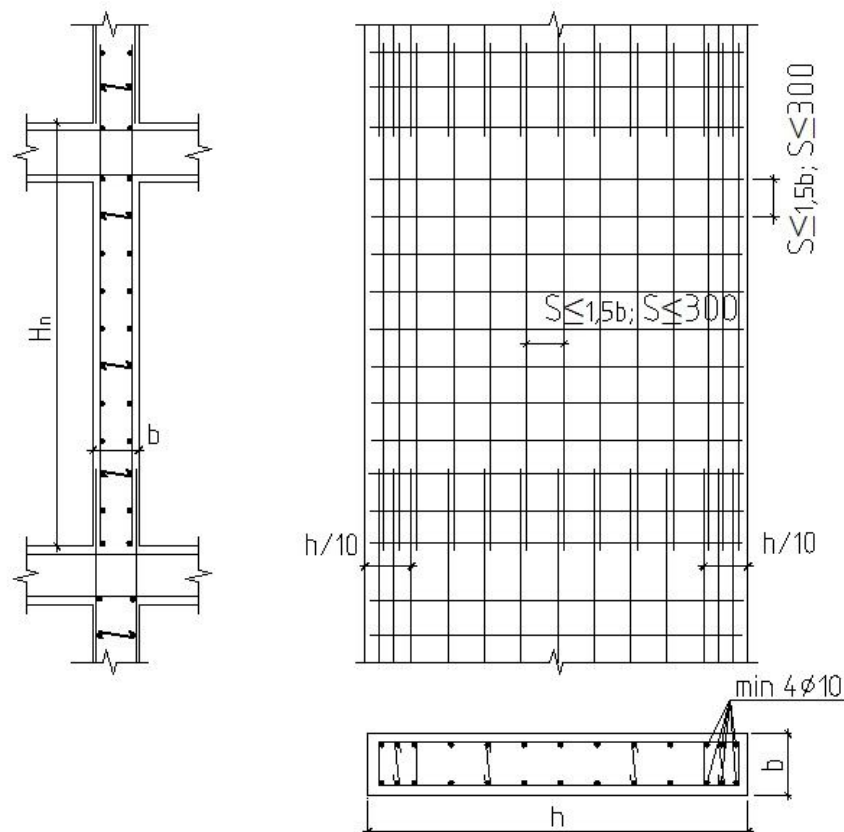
Армування діафрагми безкаркасної будівлі
